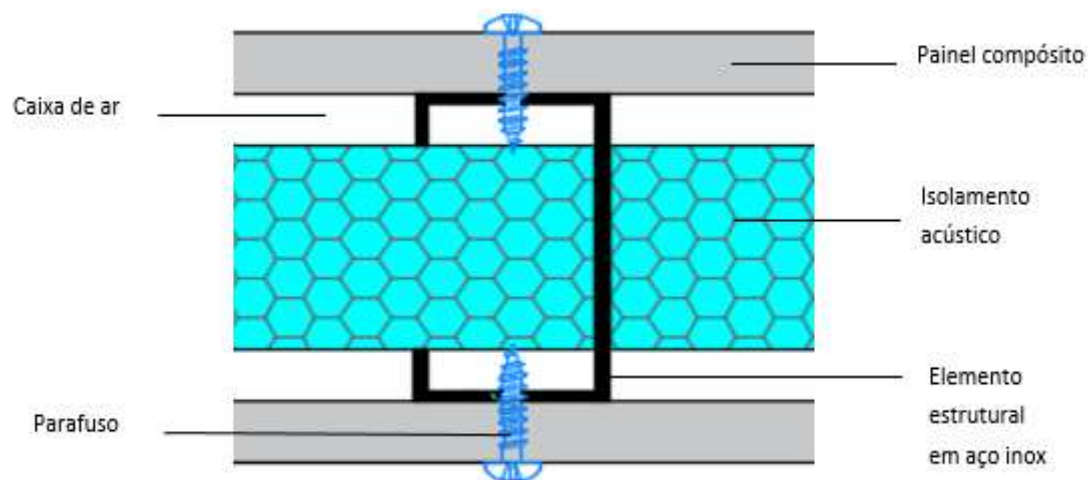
Secção horizontal da parede divisória na aplicação em paredes.
